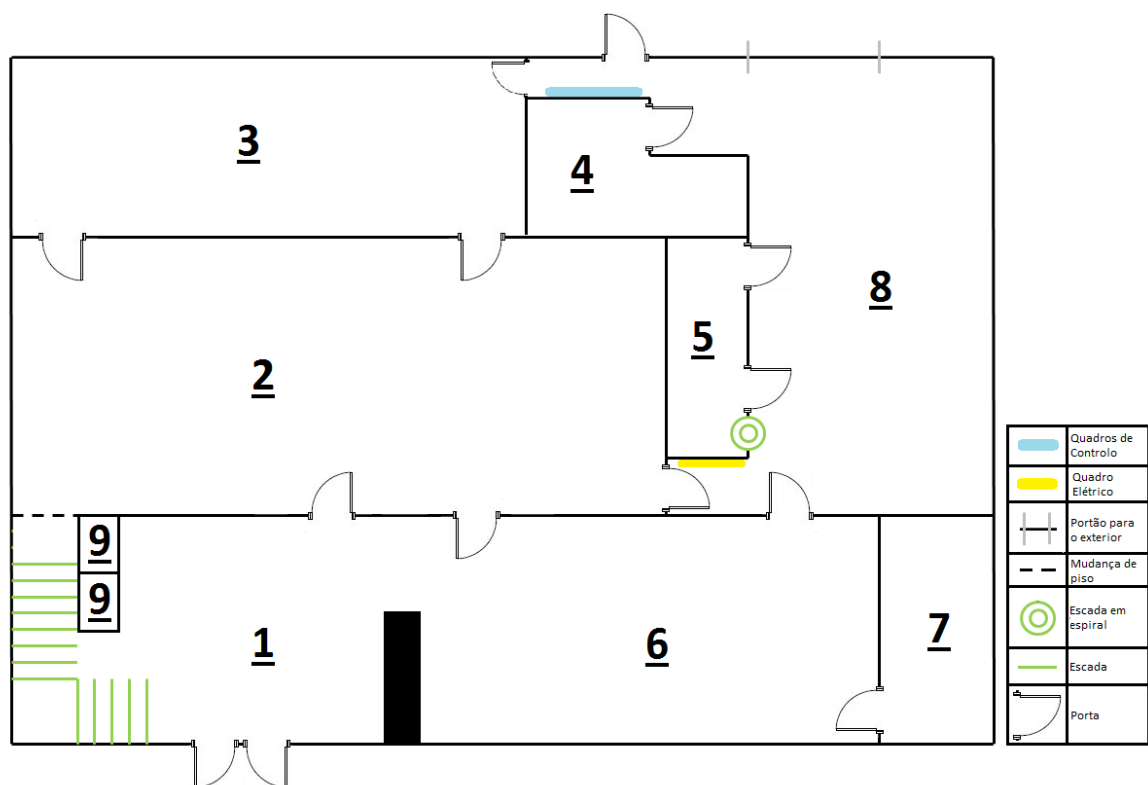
Planta simplificada do Piso 0 da TMC Iberia.
